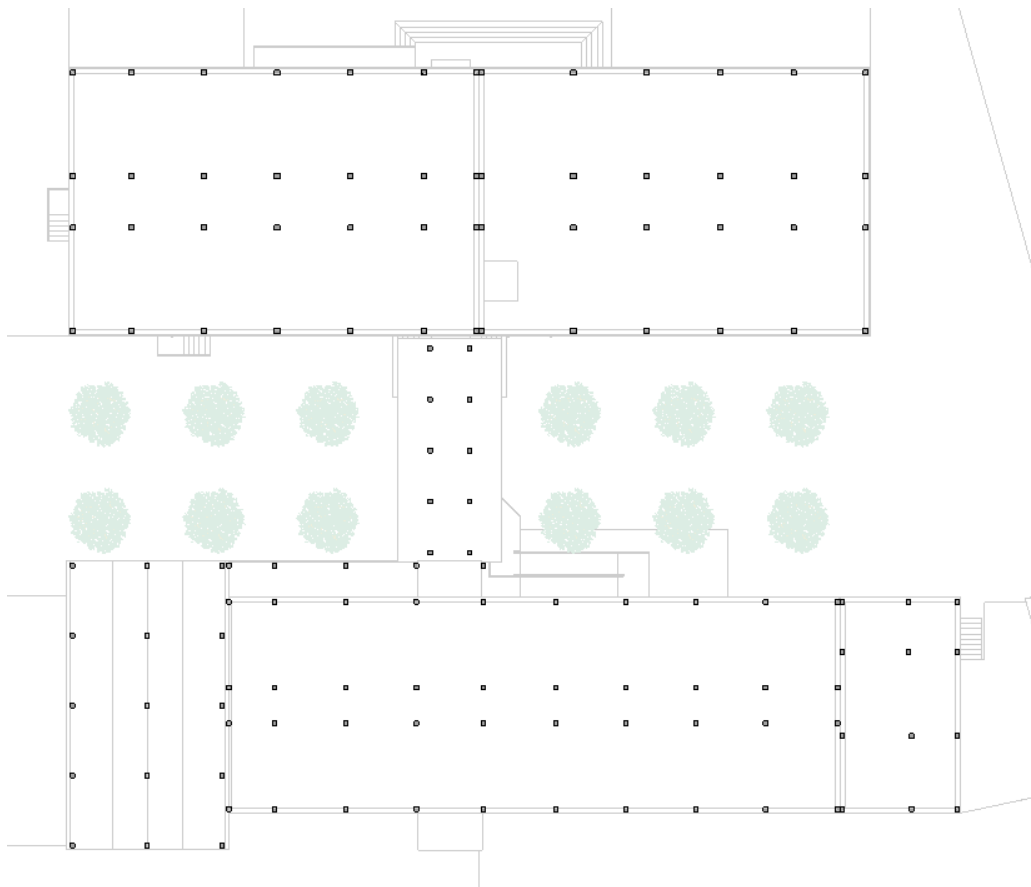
Resultado de la colocación de los pilares con el proyecto arquitectónico subyacente
